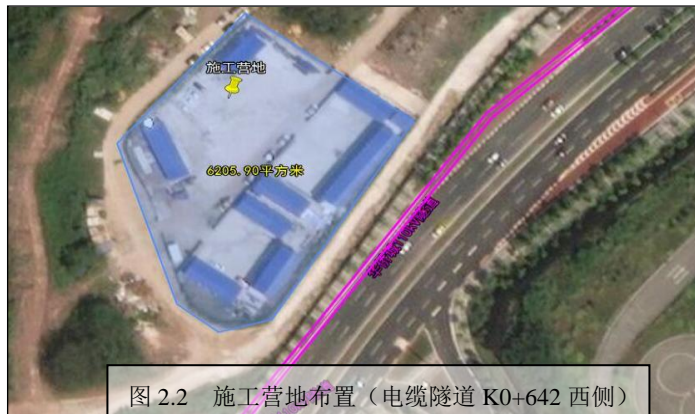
施工营地布置（电缆隧道 K0+642 西侧）
